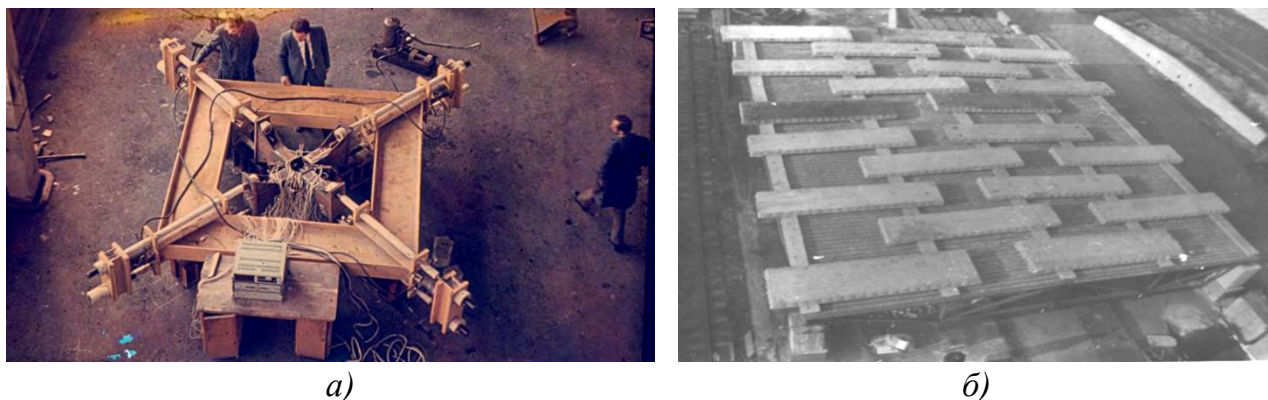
Снимки испытаний узлового соединения перекрестных ферм (а) и опытно-промышленного блока покрытия размерами в плане 19,2×15,2 м (б).
